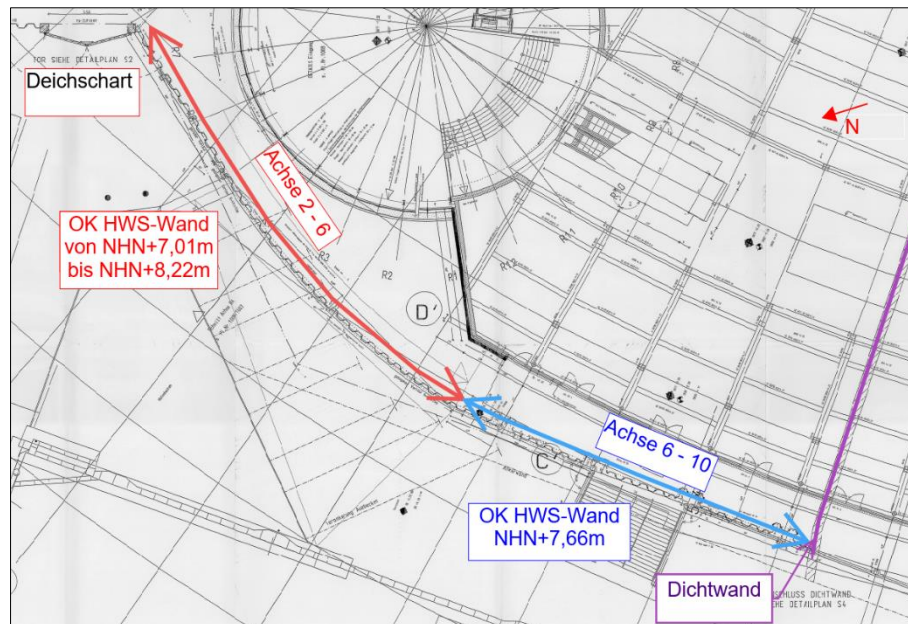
Teilabschnitt I – Öffentliche HWS-Wand (Ausschnitt Plan L1b, Stand: 15.11.2001)
